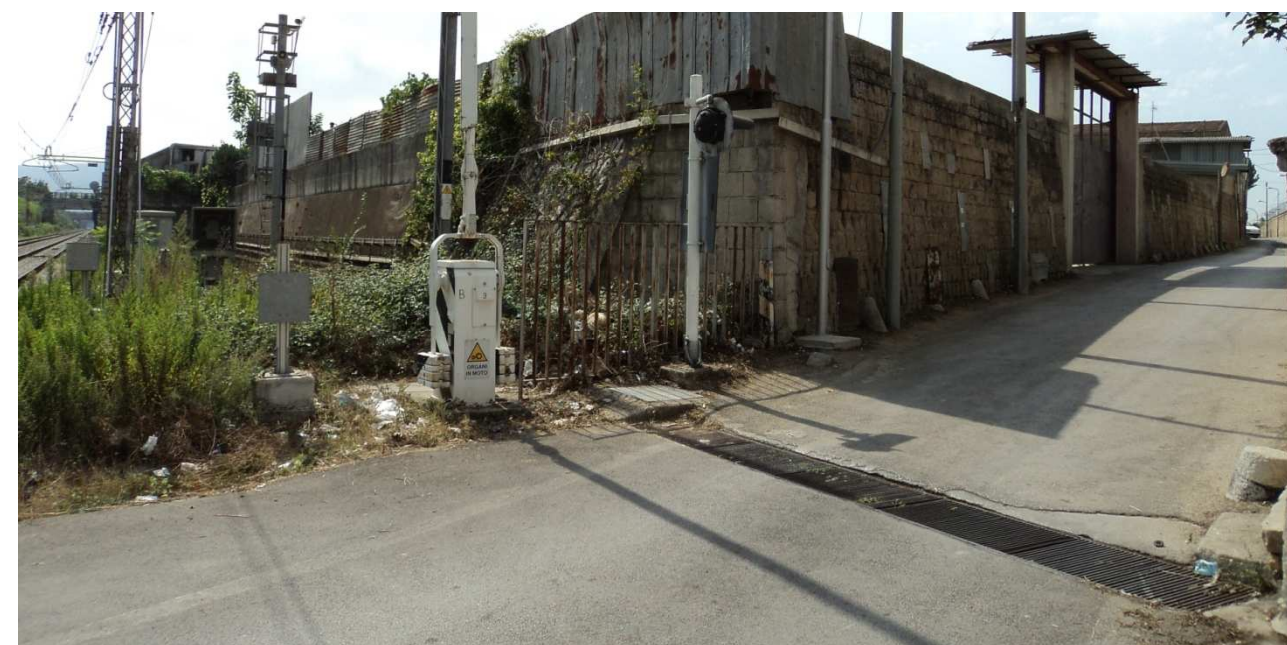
P.L. a Via S. Maria della Consolazione, al Km 222+139 della linea storica: vista lato sud
